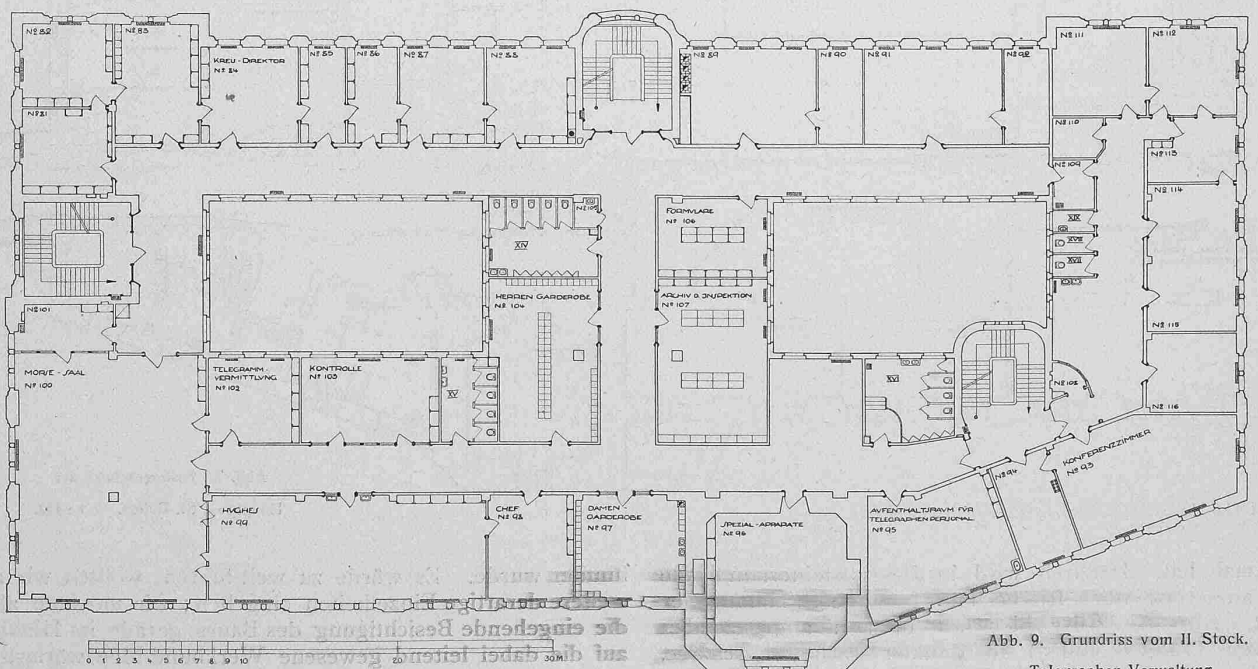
Grundriss vom II. Stock. Telegraphen-Verwaltung.
